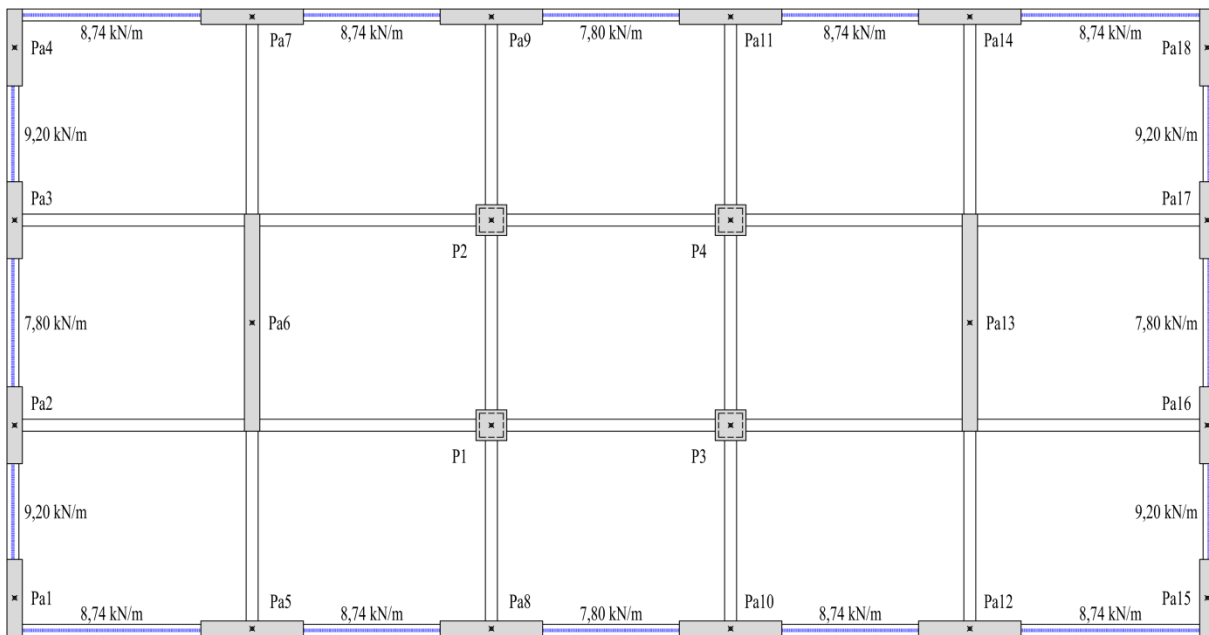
Cargas lineares aplicadas nas vigas das alvenarias nas fachadas
